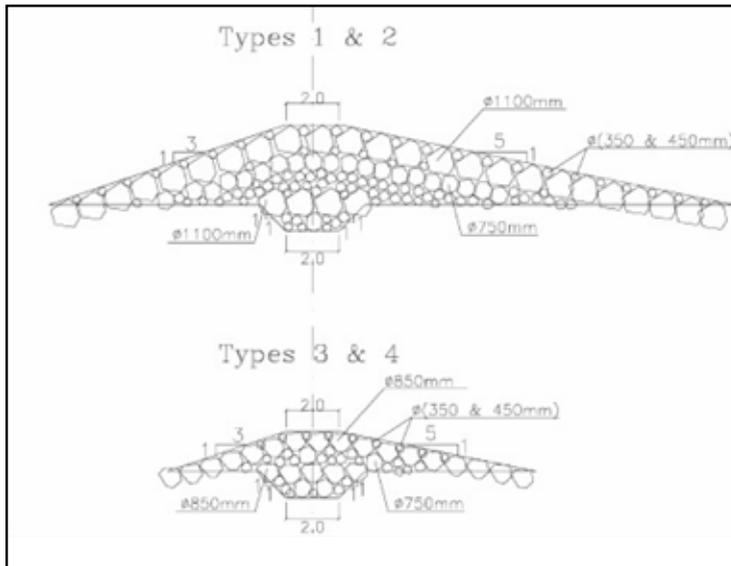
Coupes transversales types de barrages de retenue de 3 m et 1,5 m de haut dans l'oued Bahman, Yémen.
